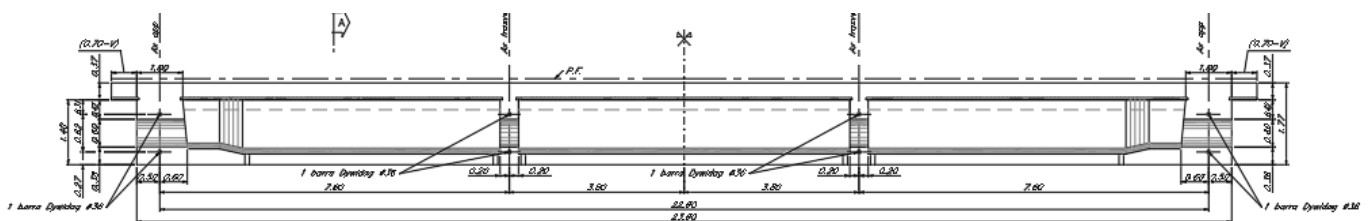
Ponte Frestola: Sezione longitudinale impalcato
